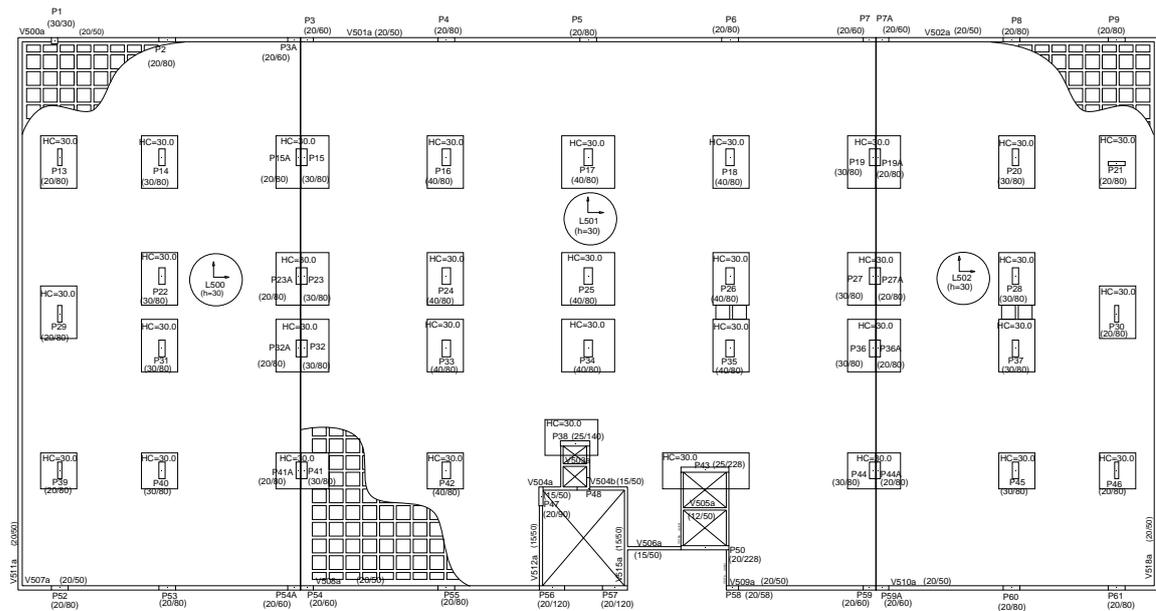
Detalhe da viga de transição no pavimento 01 do Edifício 02
